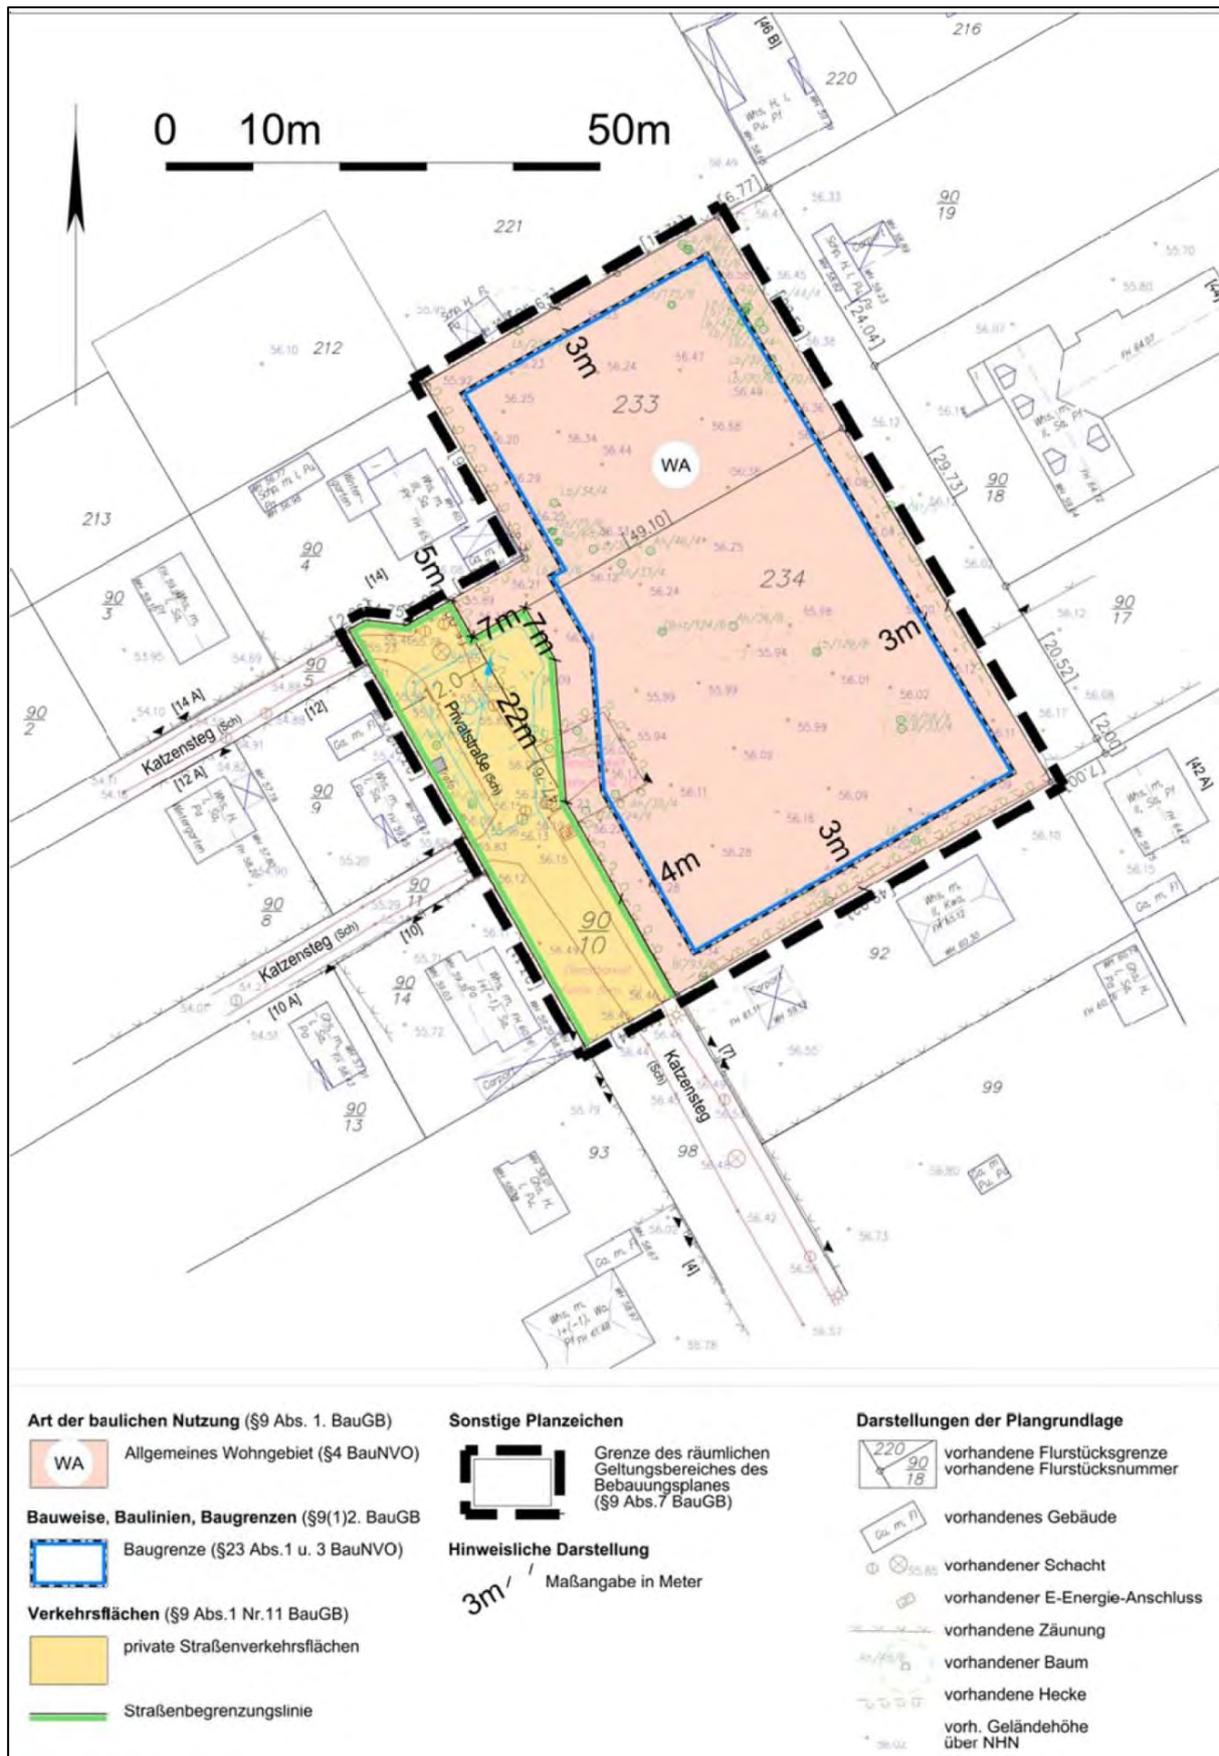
Planzeichnung des Bebauungsplans GML 30, Entwurf /32/
